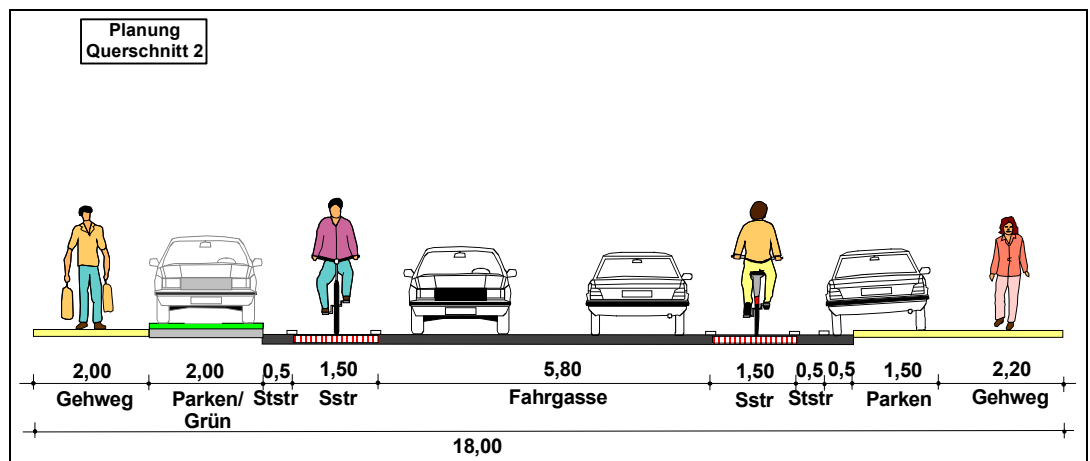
Elsässer Straße –Planung Abschnitt 2
